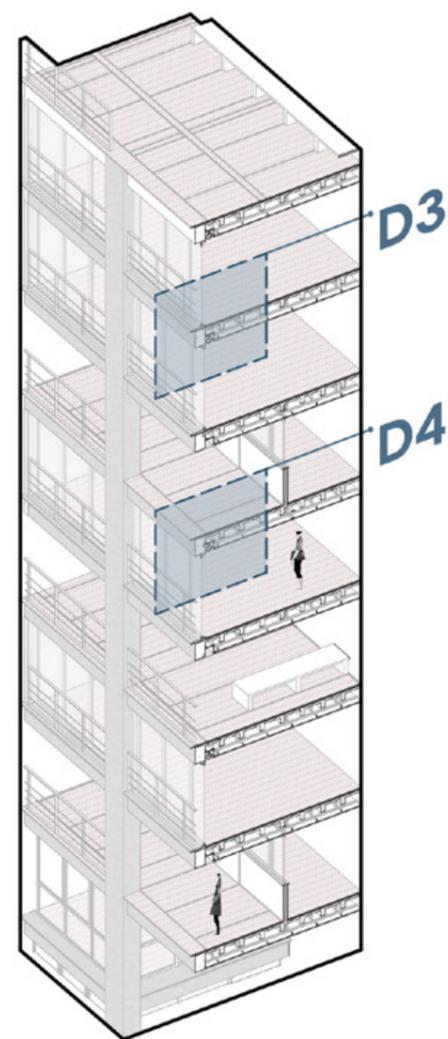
Axonometría de sección constructiva 2. Fuente: Elaboración propia.
